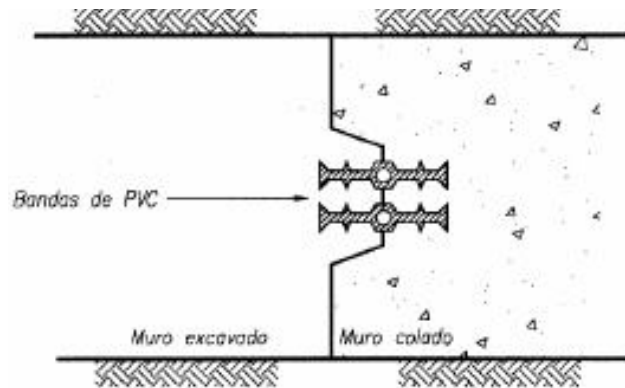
Vista en planta. Junta doble sello en pantallas (SMMS, 2002)
